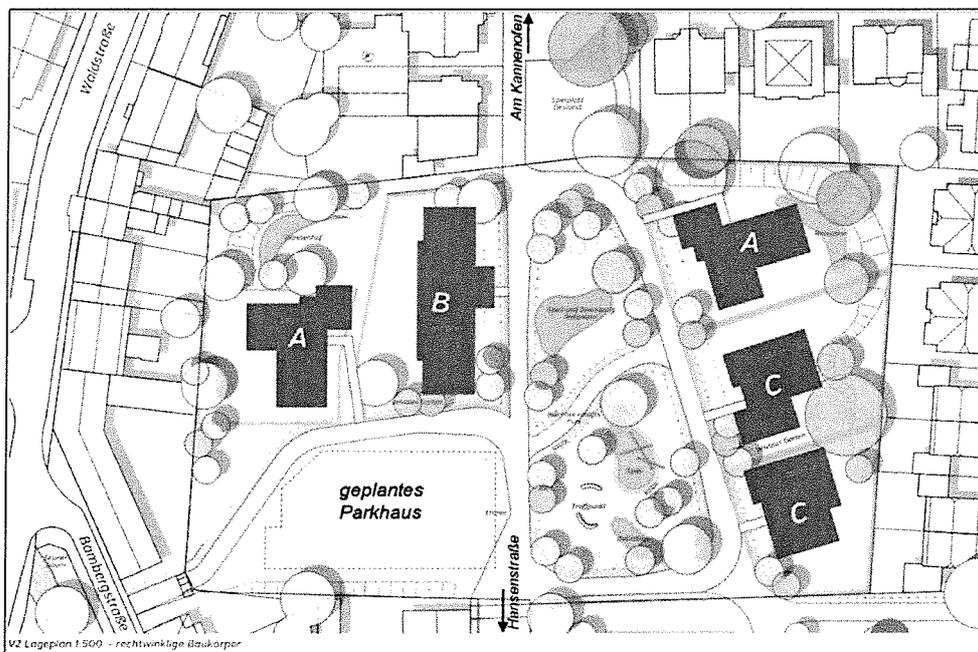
Lageplan Neubaugebiet Waldstraße (Quelle: Stadt Siegburg, bearbeitet)
